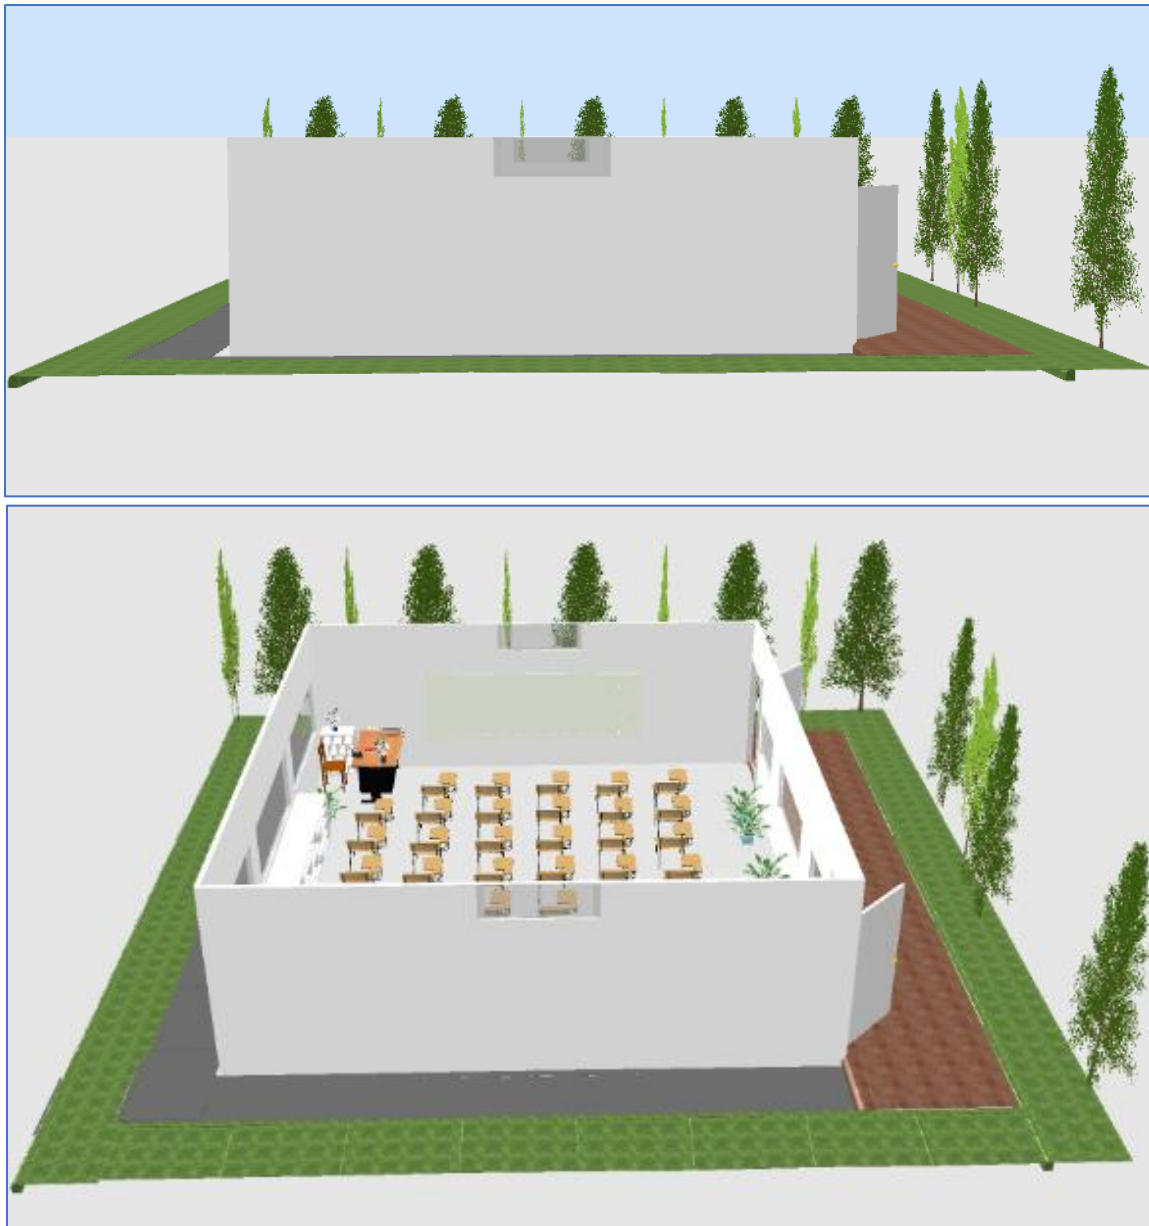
Fachada noroeste del aula: vista frontal y aérea.
